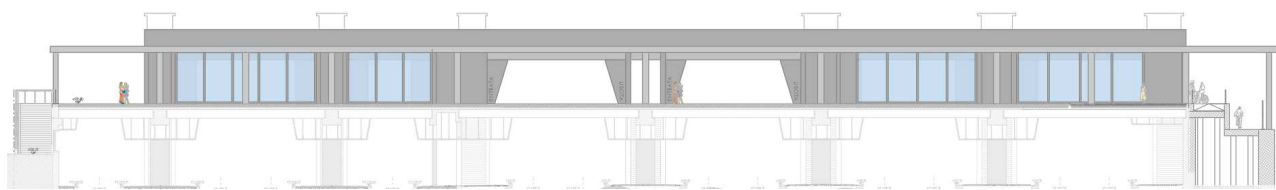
Sezione trasversale in corrispondenza del piazzale lato Milano – prospetto sud.
